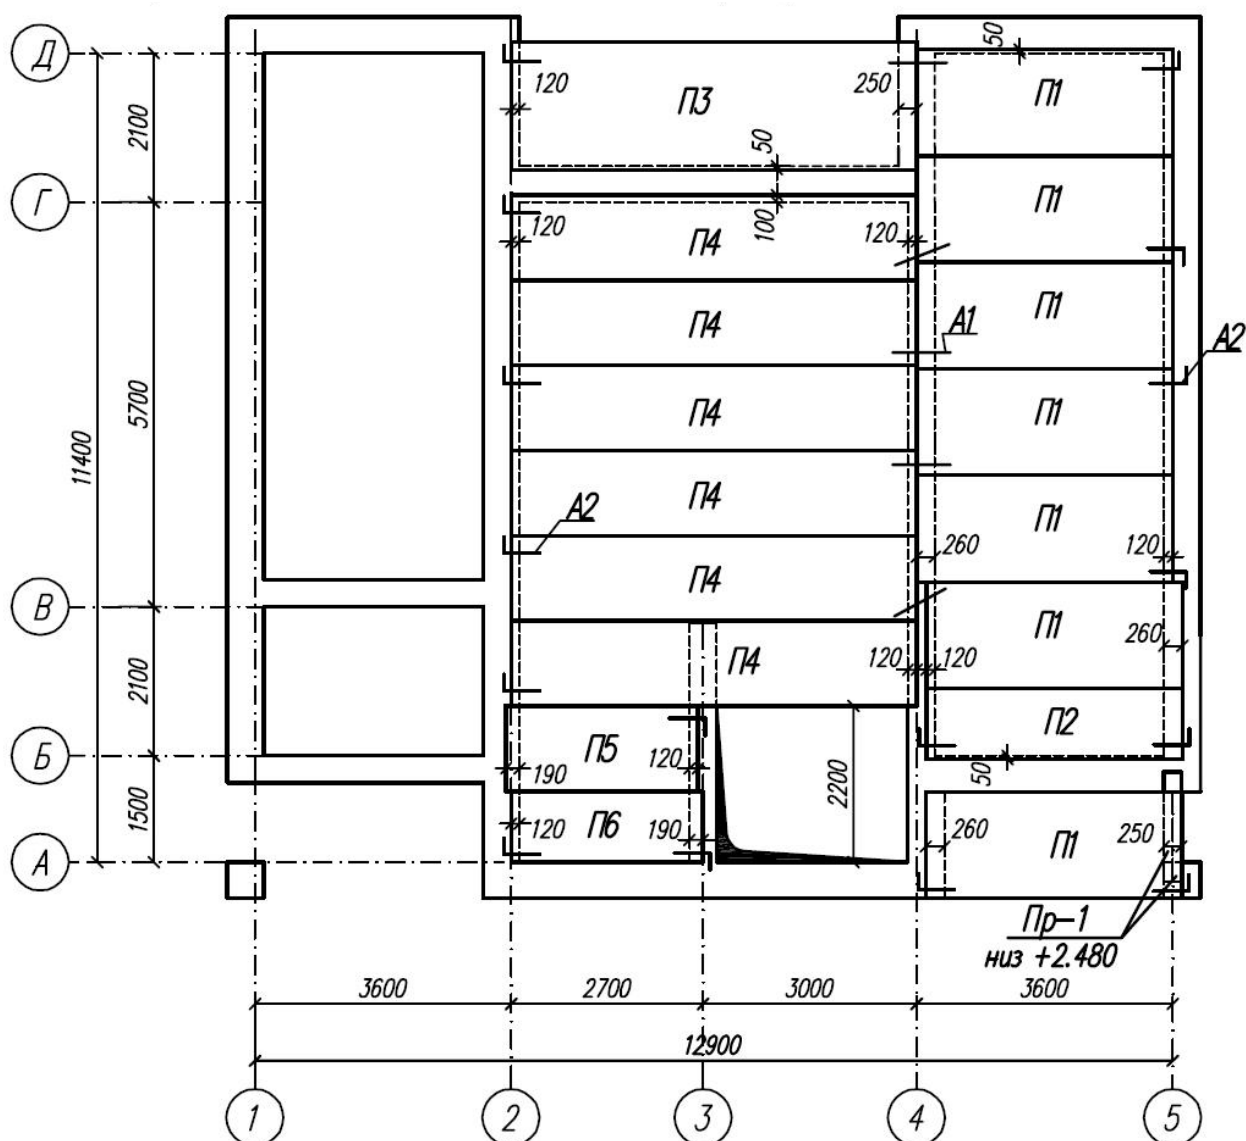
Схема расположения элементов перекрытия на отм. +2700
